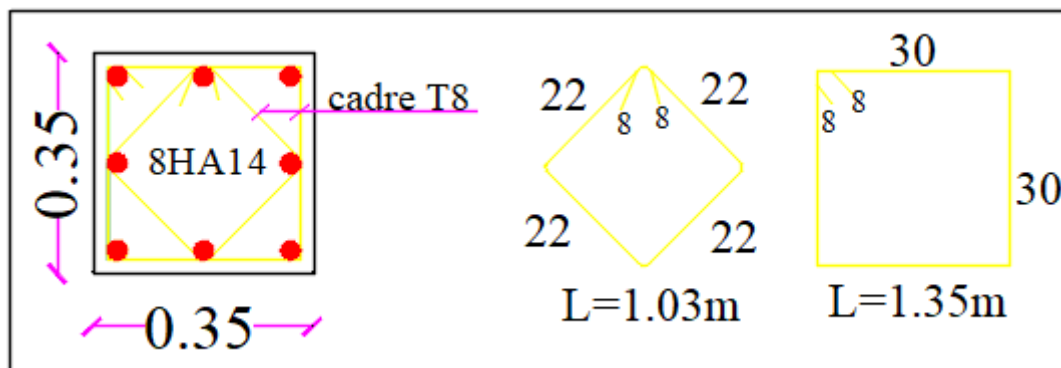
Ferrailage des poteaux 35 x 35.
